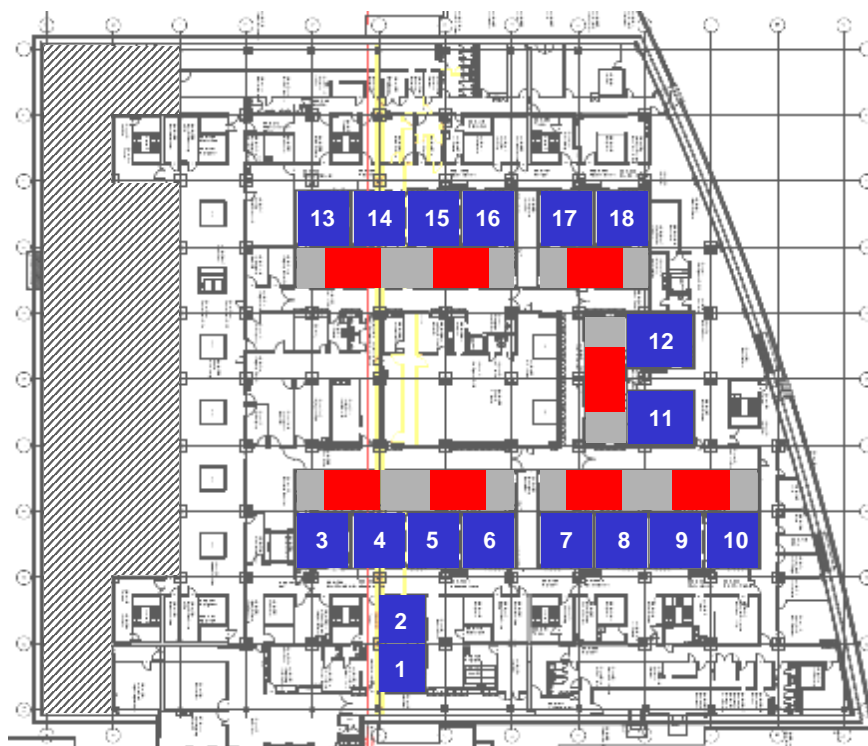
Im Jahre 2000 geändertes Layout mit einzelnen Vorbereitungsräumen und Reihenstruktur. Anmerkung: Die schraffierte Fläche im geänderten Layout ist eine Geschossfläche, die aufgrund finanzieller Engpässe vorerst im Rohbau verbleibt und nicht ausgebaut wird. Sie wird im Projekt als „Strategische Freifläche“ bezeichnet.
